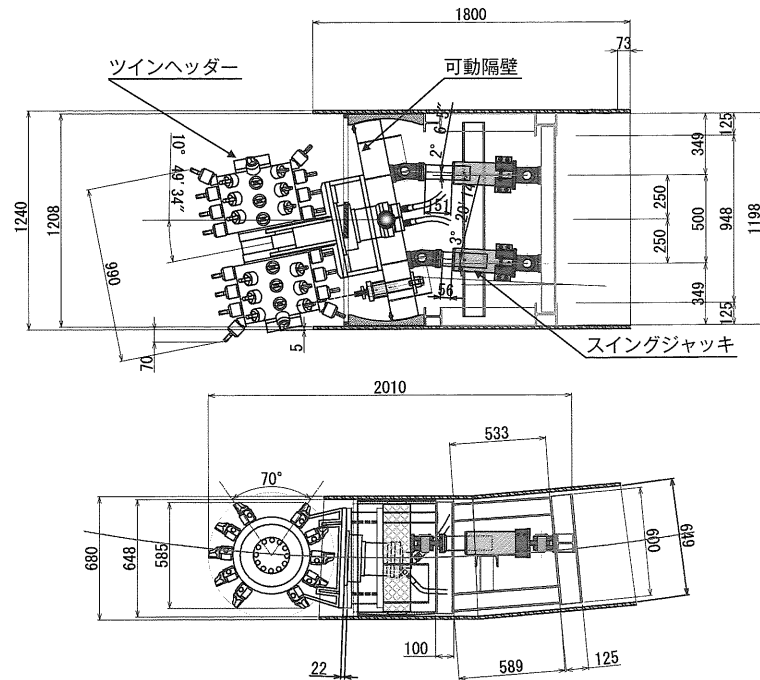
オーバーカットと引抜き回収を可能にするビット配置(上:スイング時の平面図, 下:側面図)
